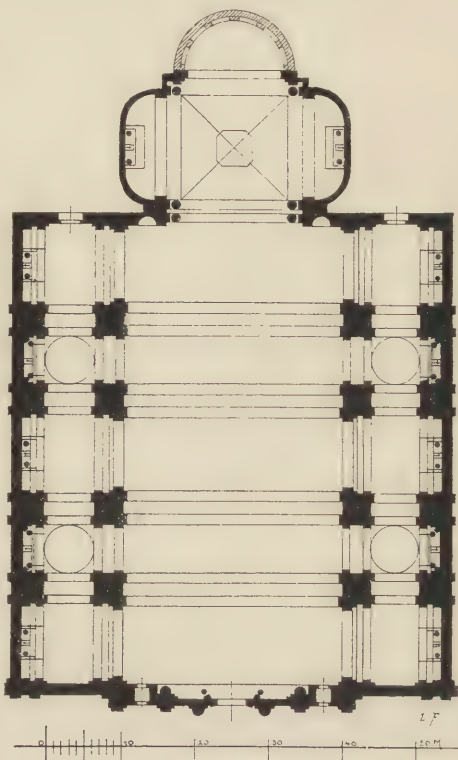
S. Pietro zu Bologna. Grundriss.
